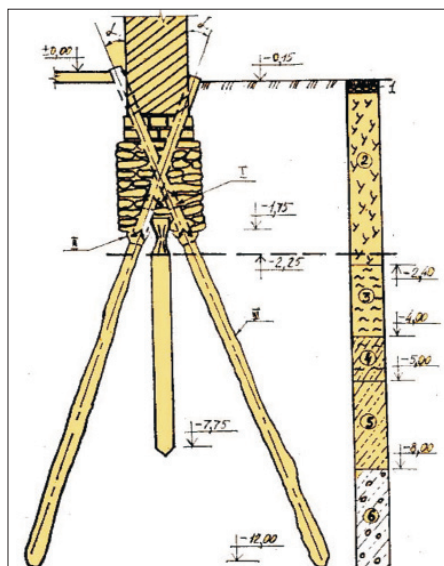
Схема усиления старого фундамента со сгнившей верхней частью деревянных свай наклонными буроналивными сваями
